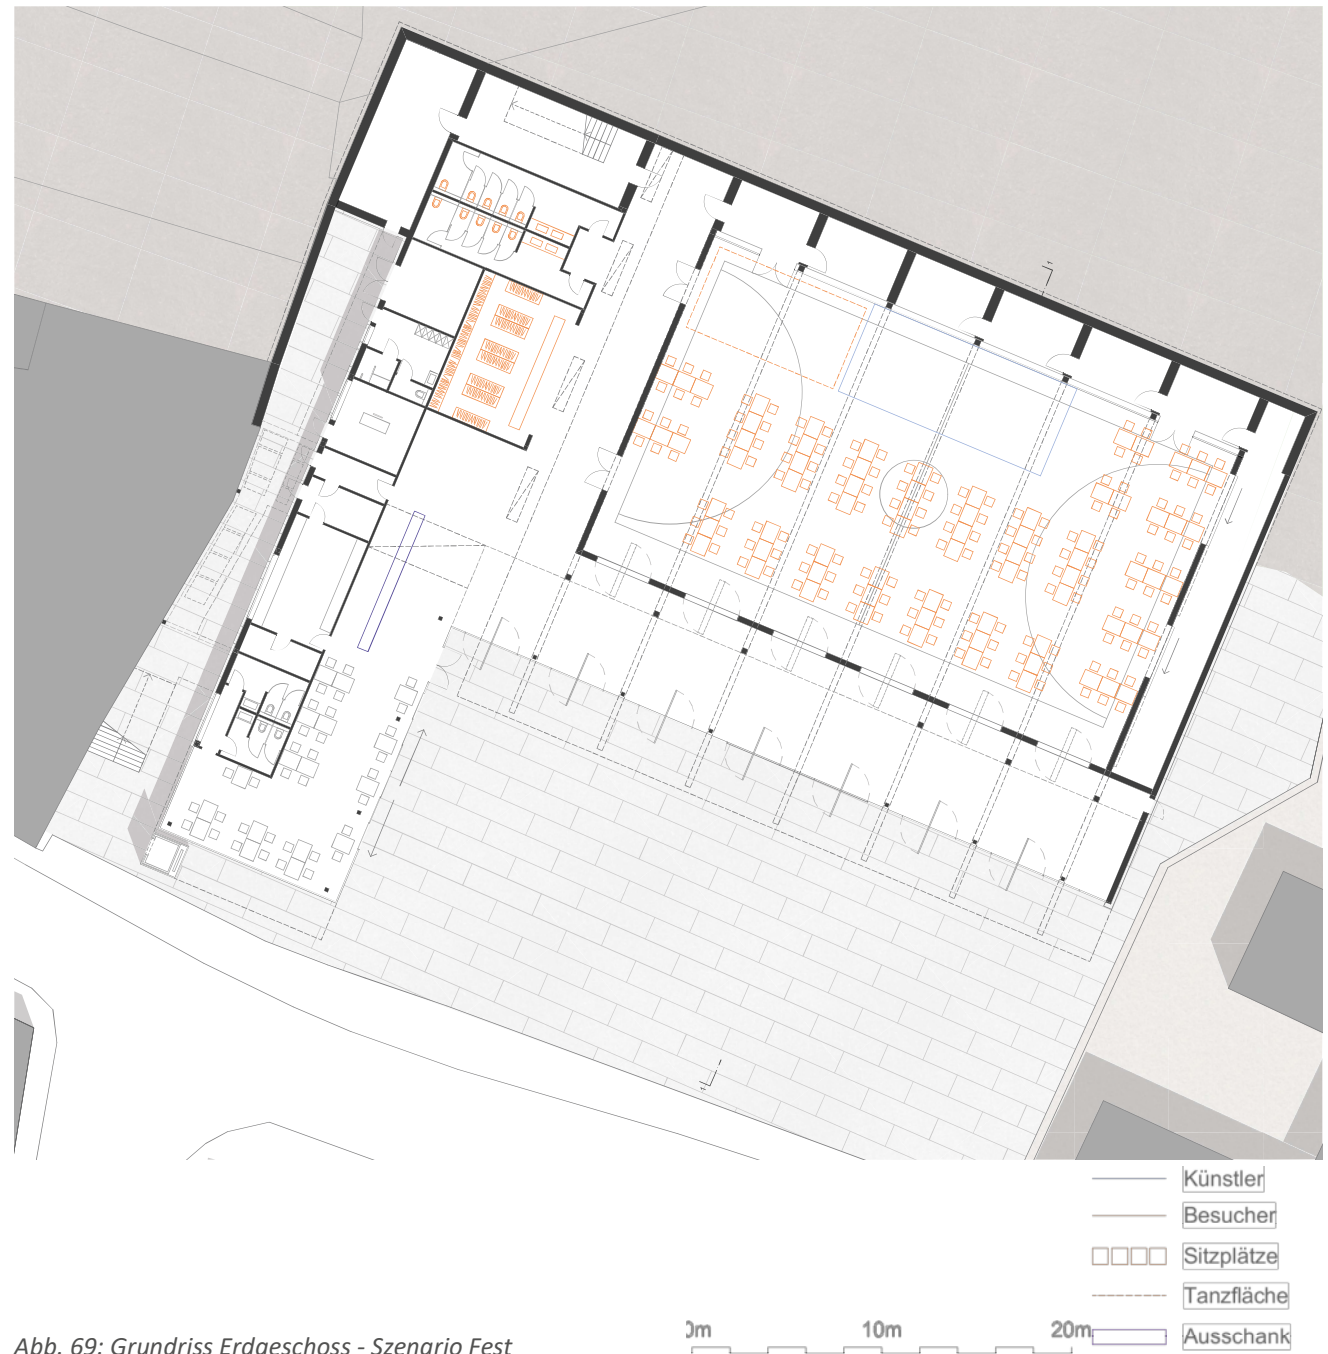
Grundriss Erdgeschoss - Szenario Fest
